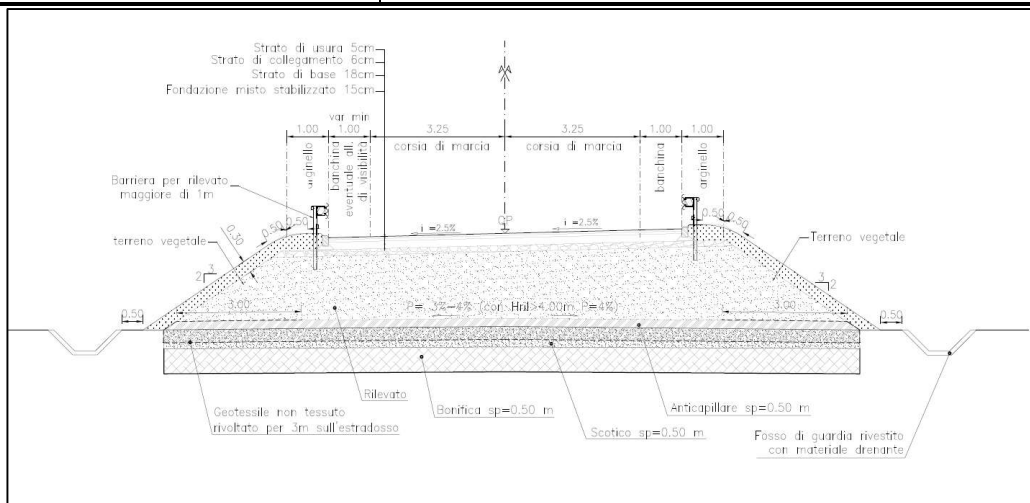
NV03 - Sezione tipo in rilevato (in curva)
